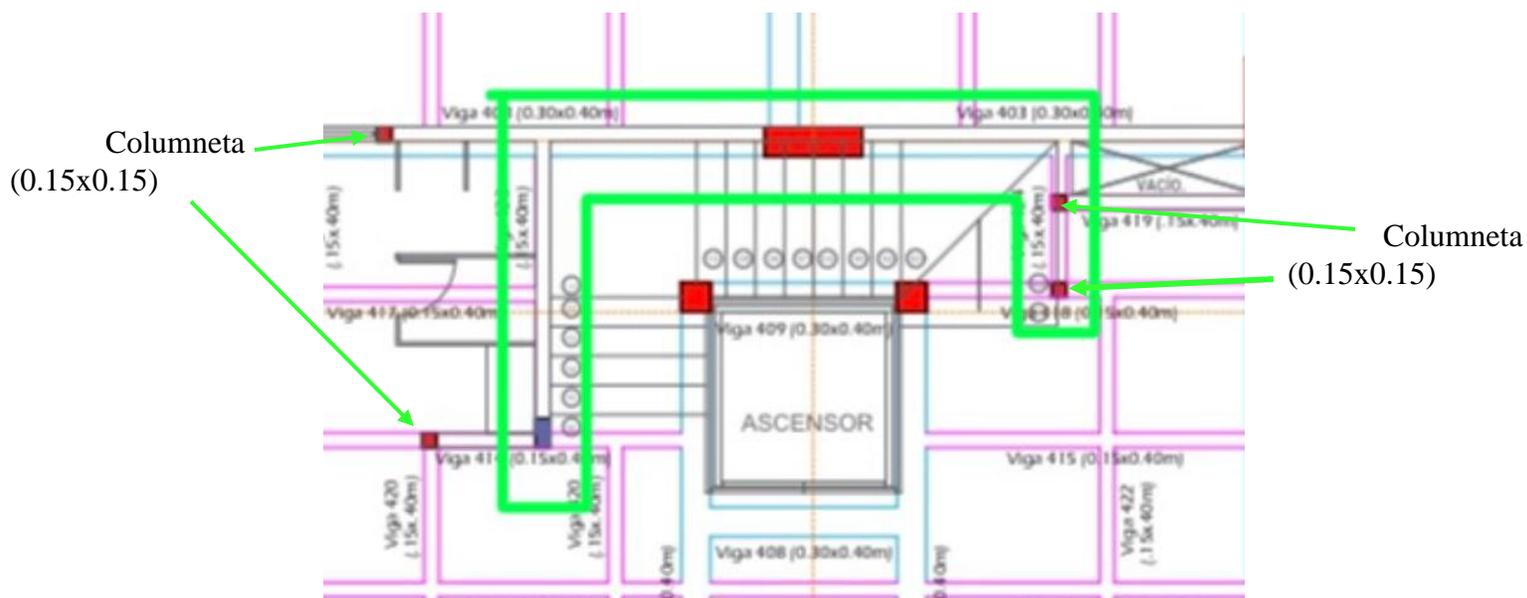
Parte señalada de muro escaleras nivel 4 ascensor vista en planta, plano estructural Wiedii
